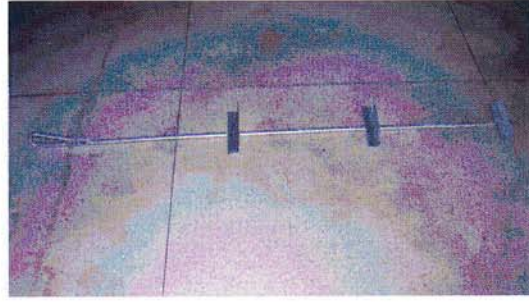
กำแพงกันดินแบบ Reinforced Earth (Reinforced earth wall)
